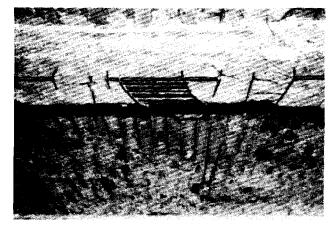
Stahlbetonbalken mit unterschiedlichem Bügelabstand nach einem Schadensfeuer (nach 58). Fig. 50. Reinforced concrete beams with varying stirrup spacing after a fire (from 58)
